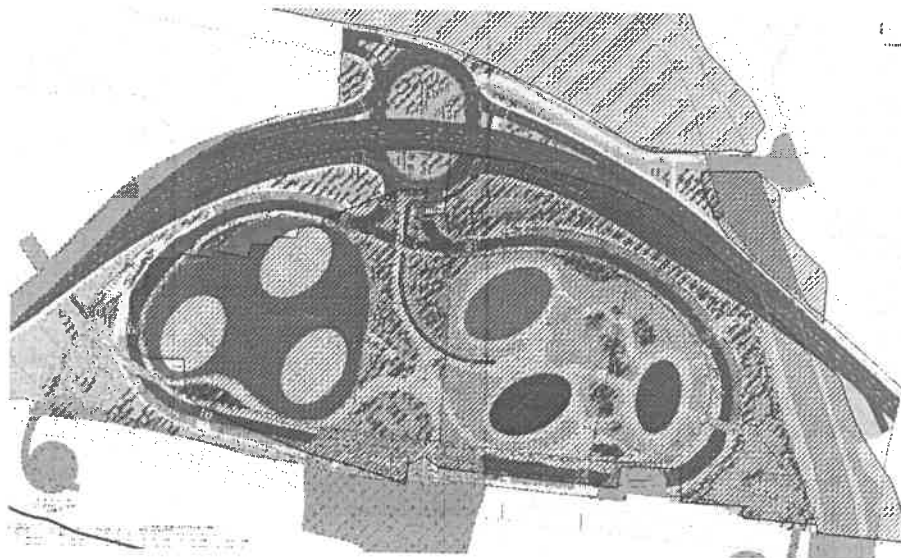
Extrato da Planta de Síntese da OL/ sobreposição com "Zona adjacente do Rio Jamor"
